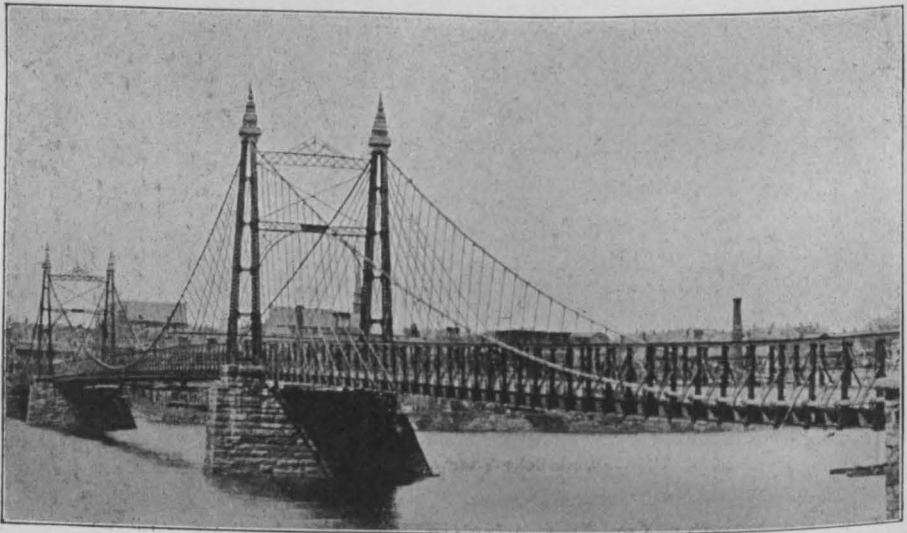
Straßenbrücke bei Windsor-Locks über den Connecticut. 1884.
